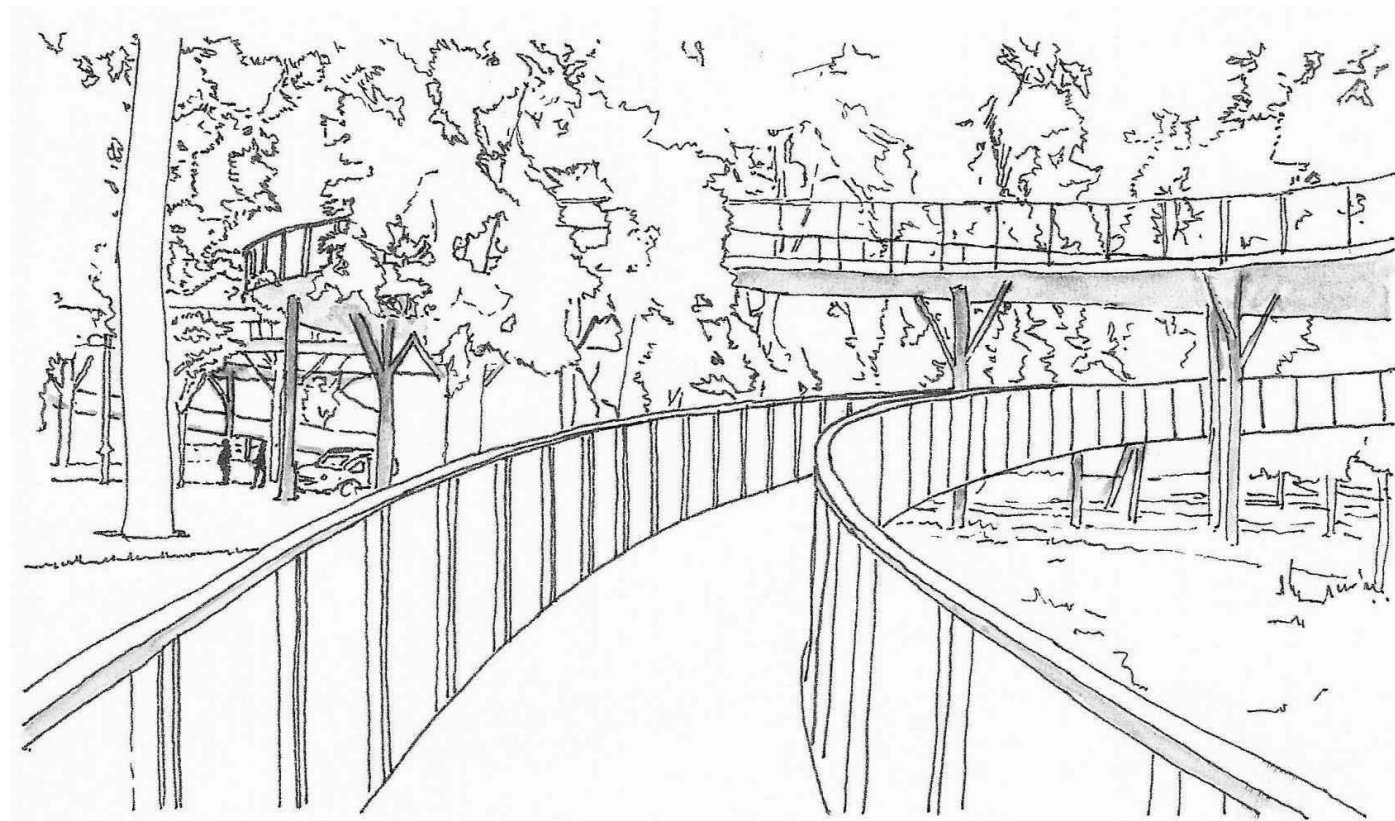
Ponte pedonal da Avenida Artur Ravara, Aveiro
